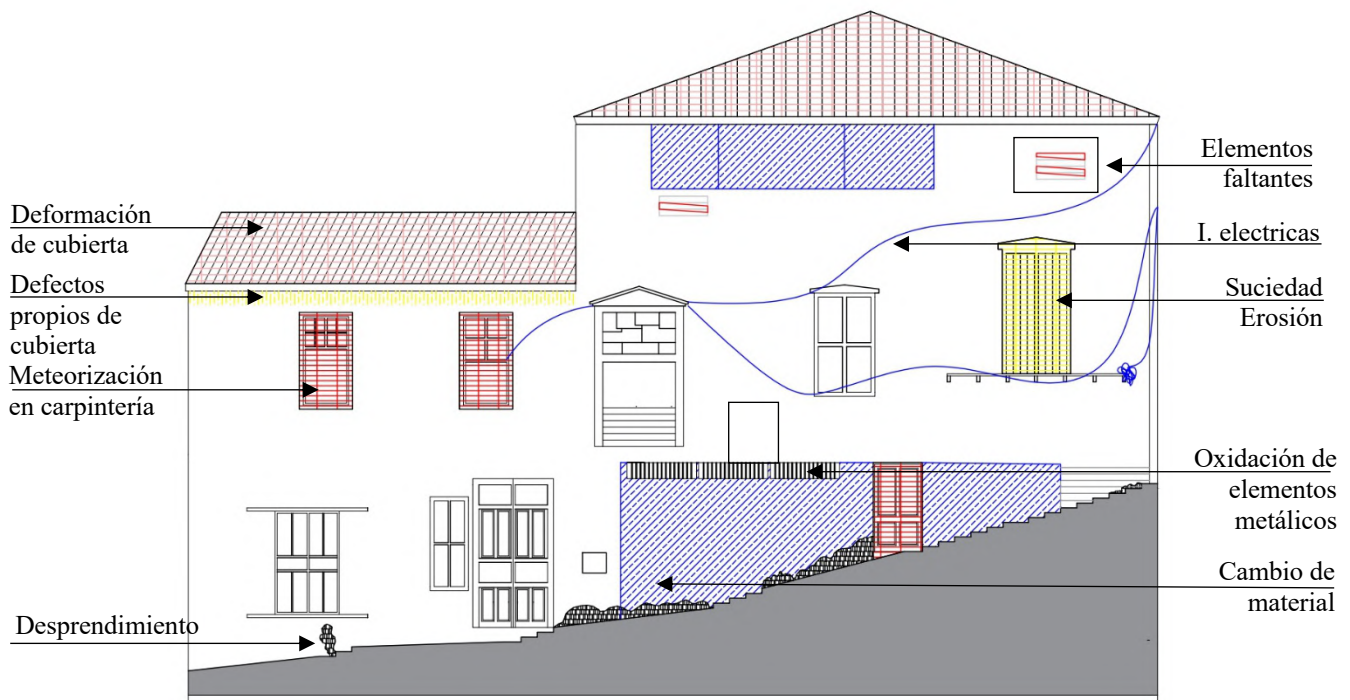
Esquema de lesiones fachada Pasaje Wilson (E: 1/200)
